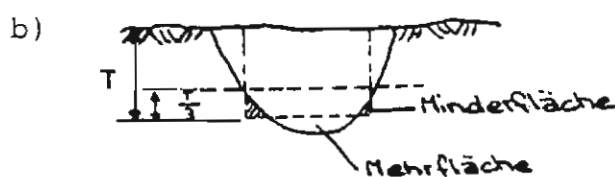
a - b Anpassung des Aushubes an die theoretischen Abmessungen
